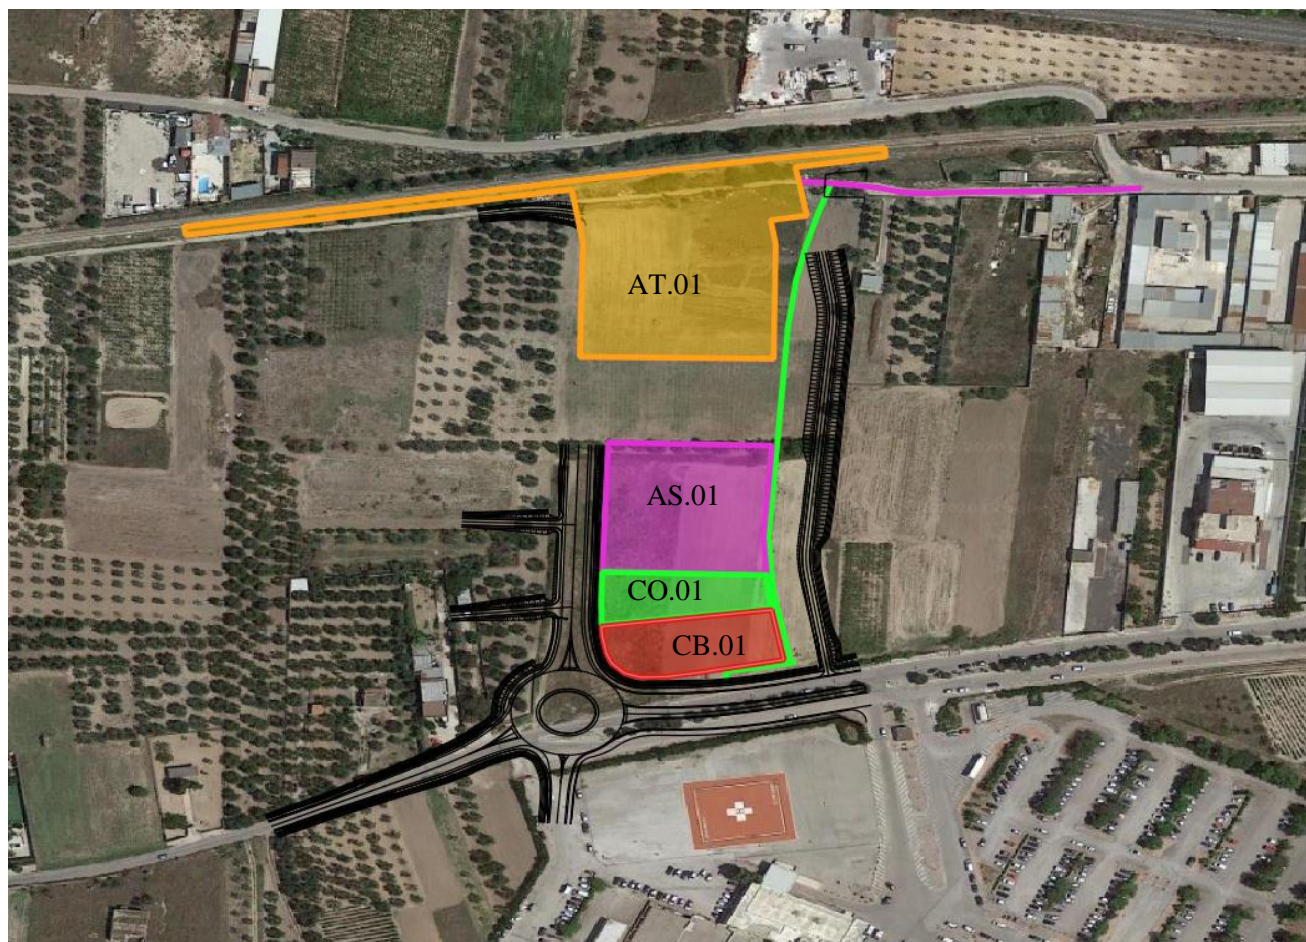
Viabilità di accesso alle aree di cantiere (in verde pista di cantiere)
